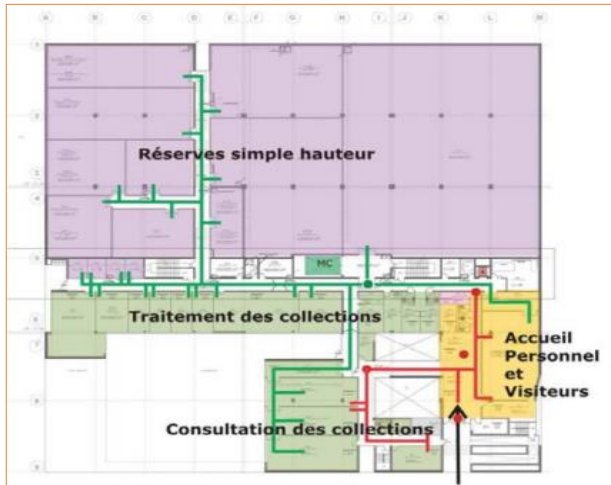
Plan RDC de centre de conservation Marseille. Source : <https://www.archdaily.com>
